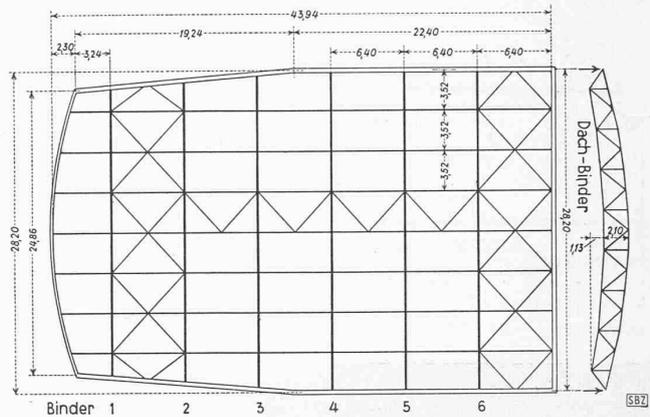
Kongress-Saal, Dachgrundriss 1 : 600
